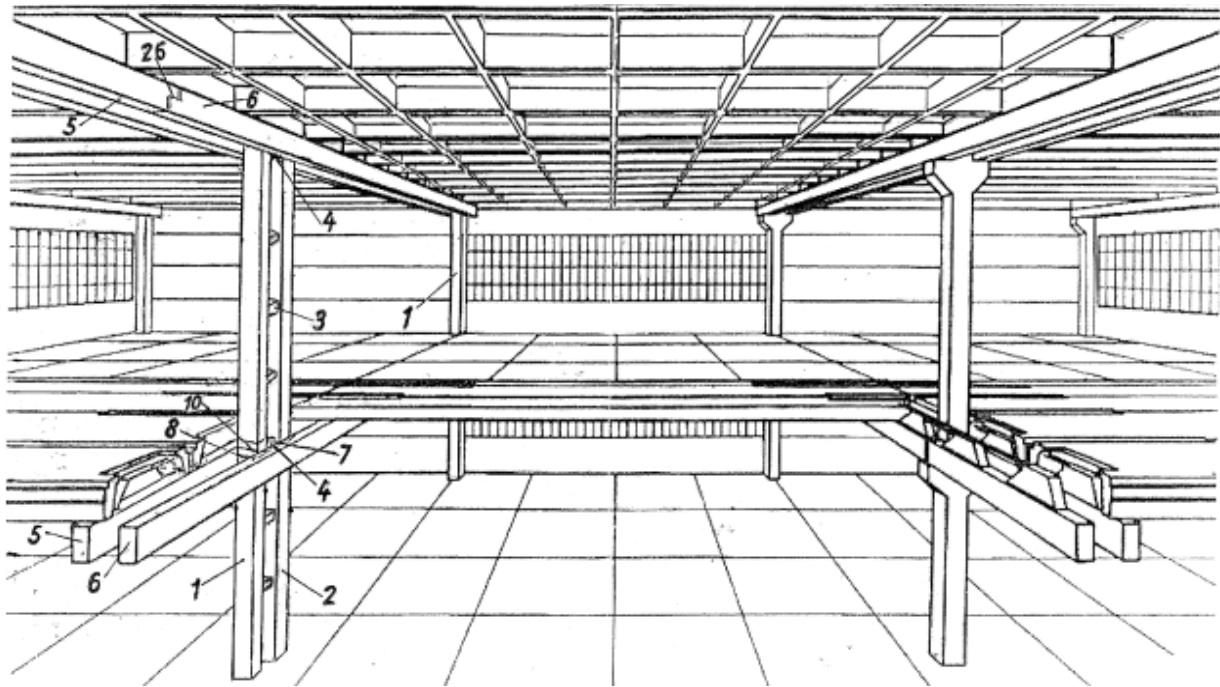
Житлова будівля із збірним залізобетонним каркасом [4]
